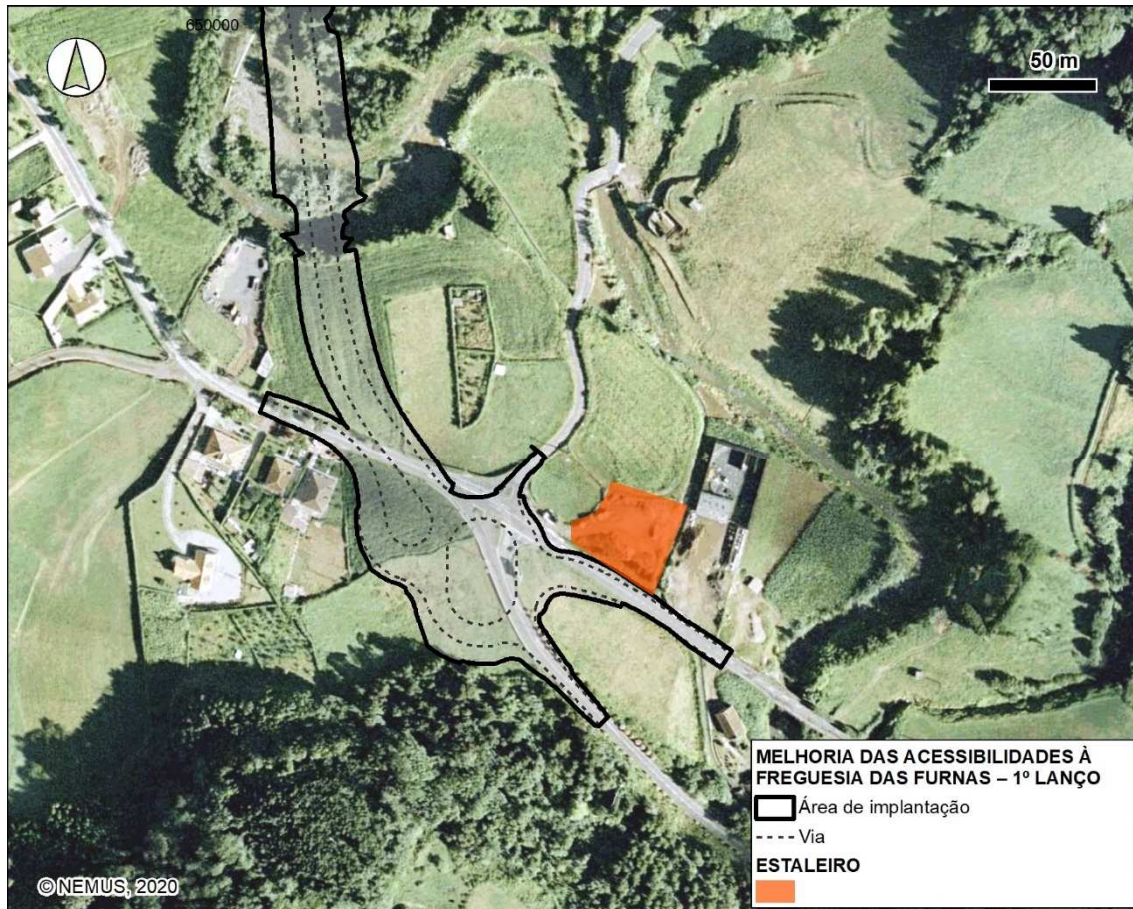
Localização para o estaleiro da obra e de outras instalações provisórias de apoio à obra
